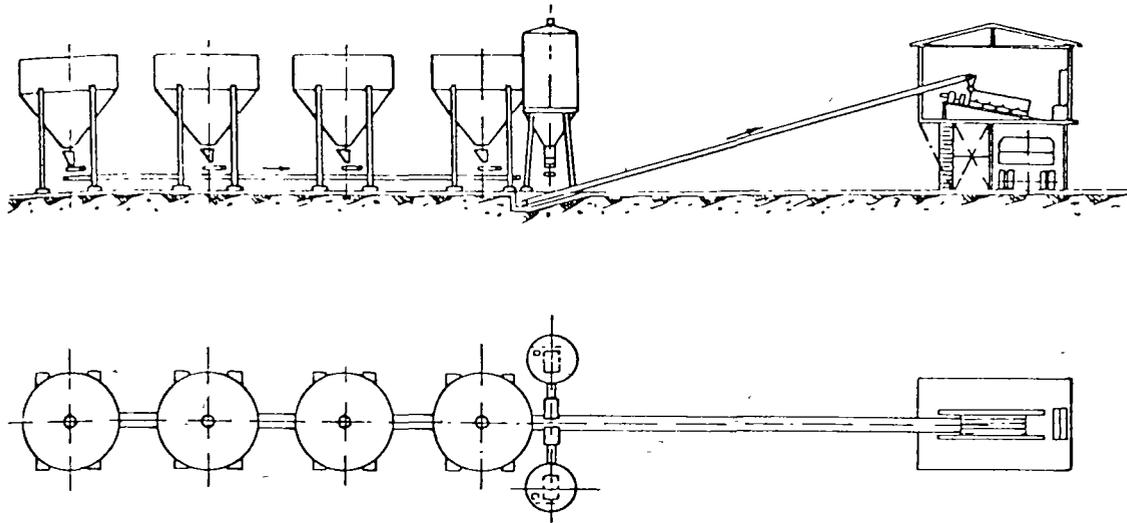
Planta central de concreto Autocrete ( Europea ).
